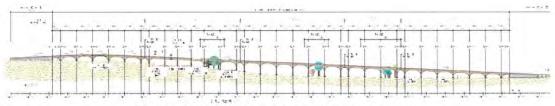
Vista de la sección longitudinal del proyecto. Fuente: Planos de Proyecto, 2021.
